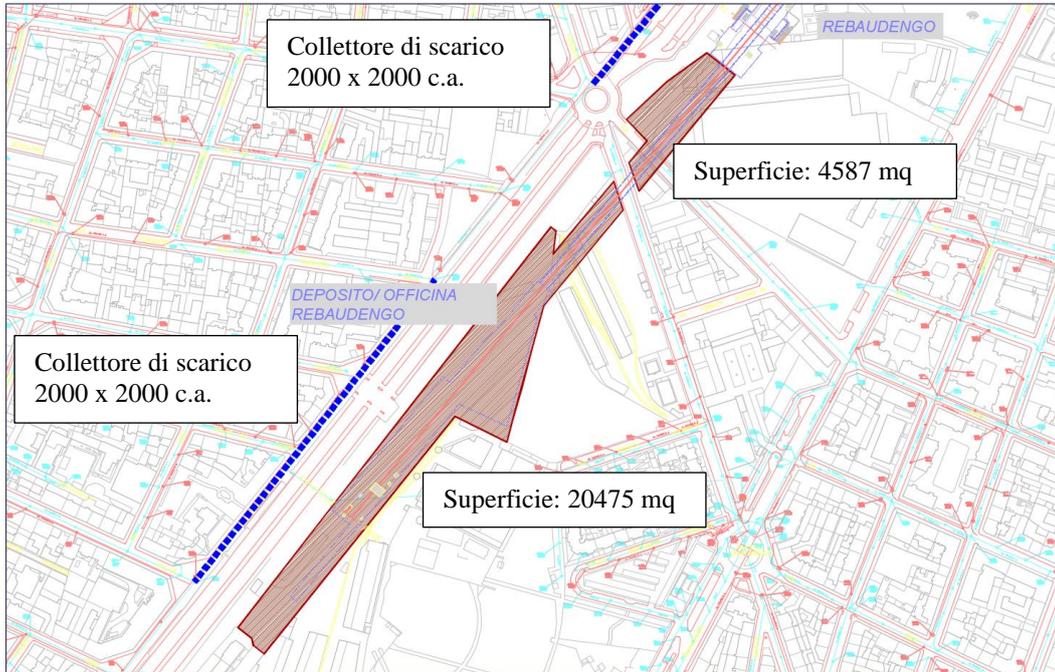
Aree di cantiere – Deposito/officina Rebaudengo – FASE 1
